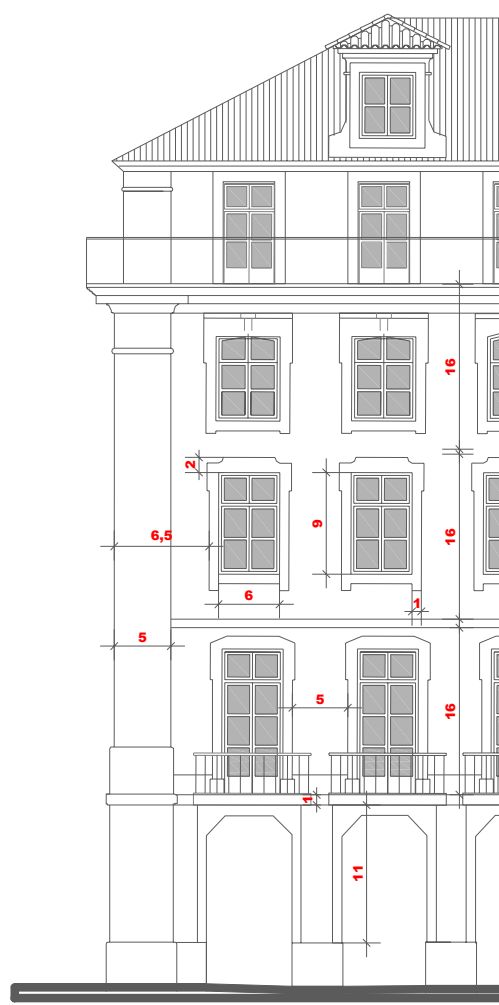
Definição modular da fachada da rua principal – Rua da Prata
